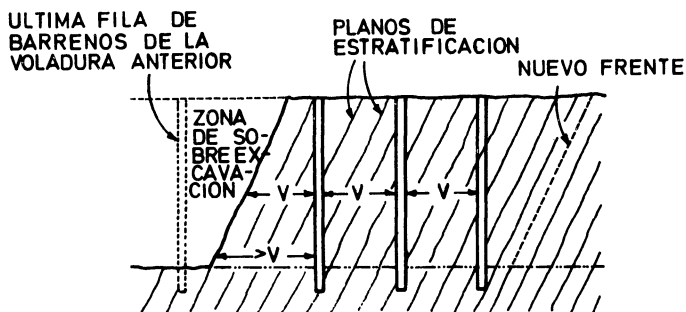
Excesiva piedra en el repiés provocada por la estructura del macizo.
